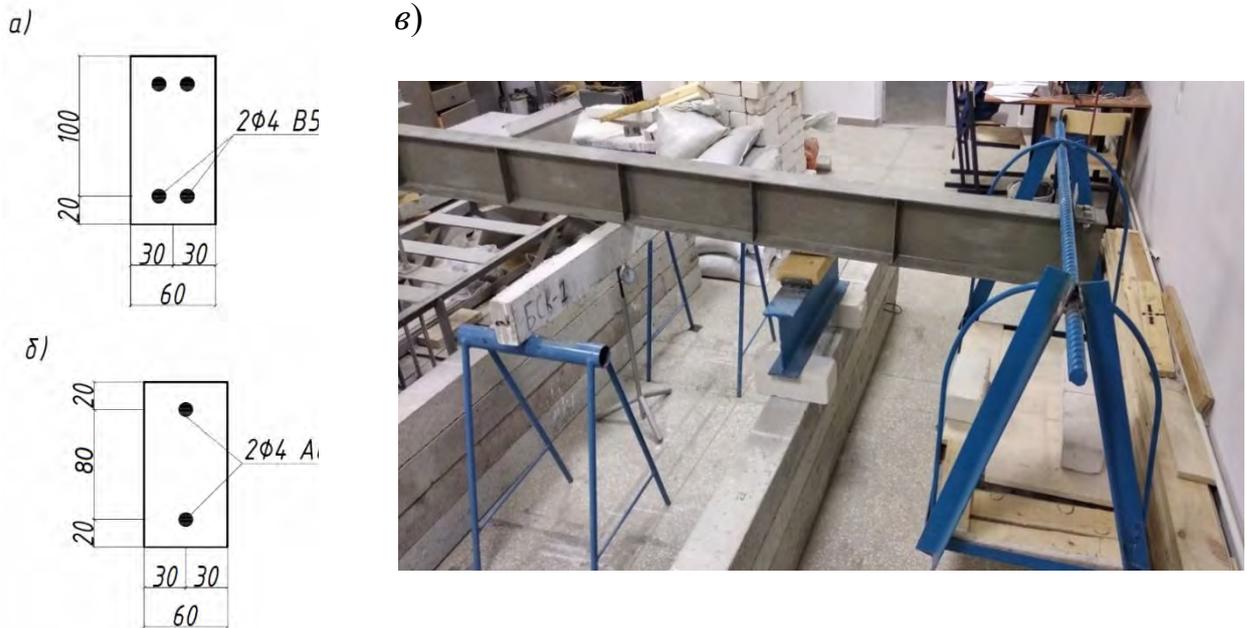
Схема армирования образцов: а) стальное; б) композитное; в) общий вид испытания
